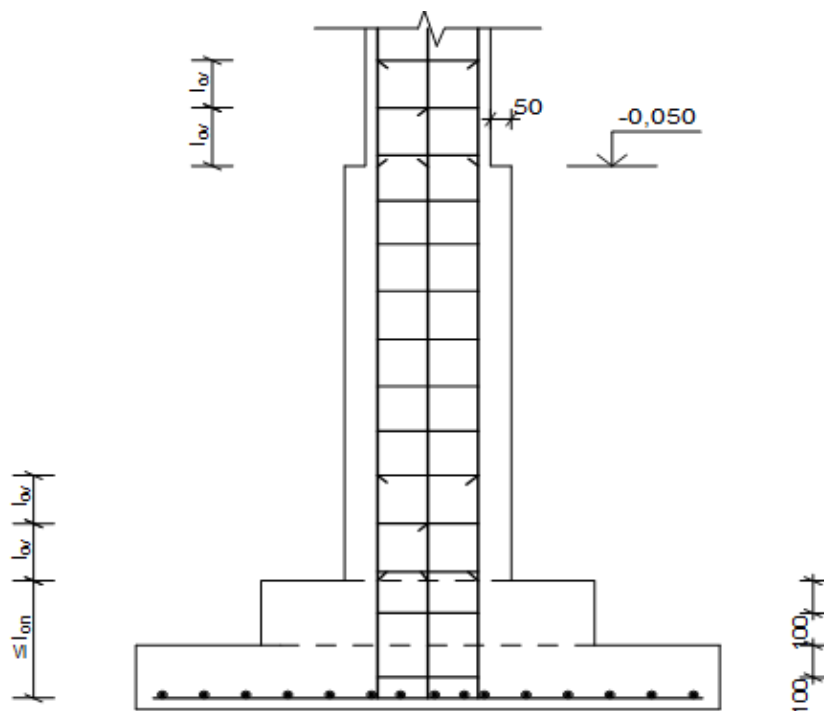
Конструкція фундаменту під монолітну колону
